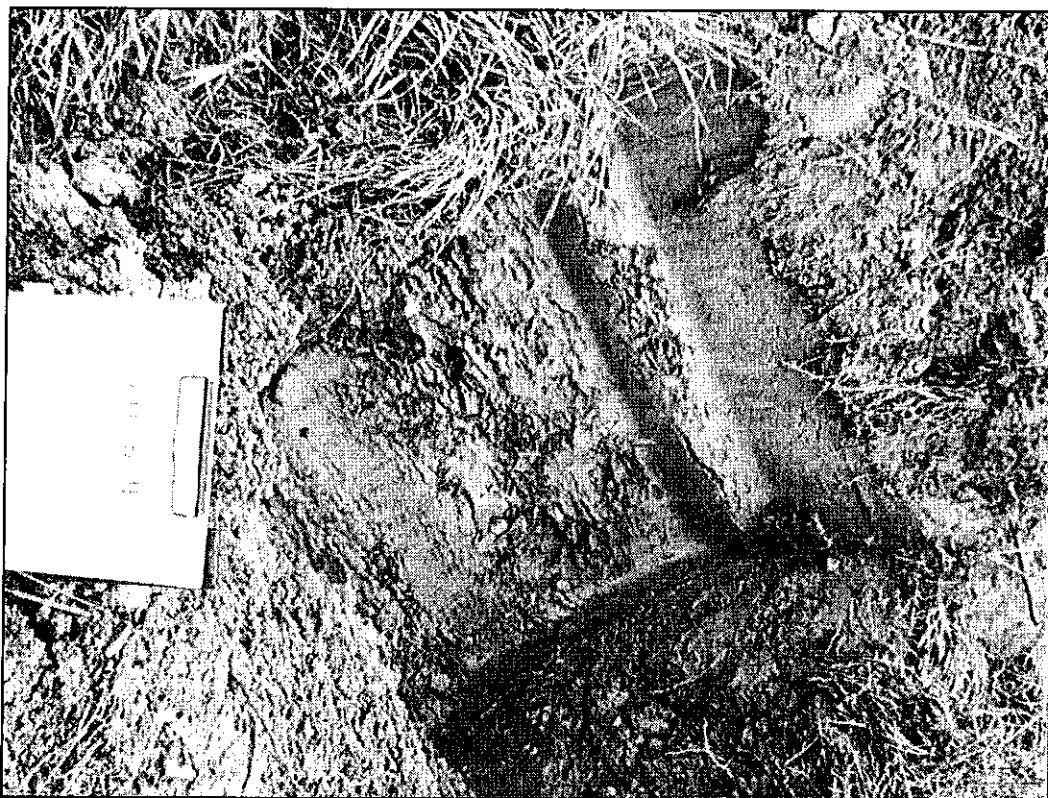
Pozzetto n° 9. Profondità -1,0 m dal p.c.
